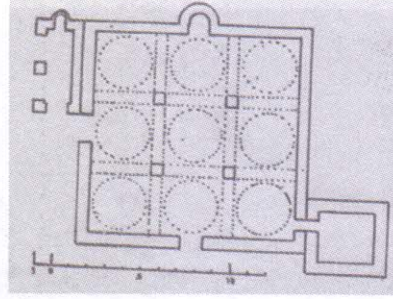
القباب (١٩ - ٣٠) ، مسقط أفقي ( عمل الباحث ) .
